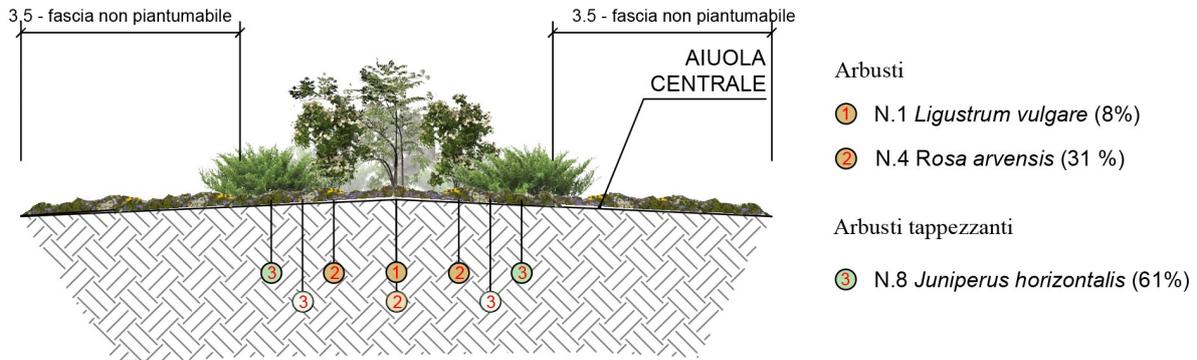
Prospetto piantagione rotatoria modulo PI-RO 3
